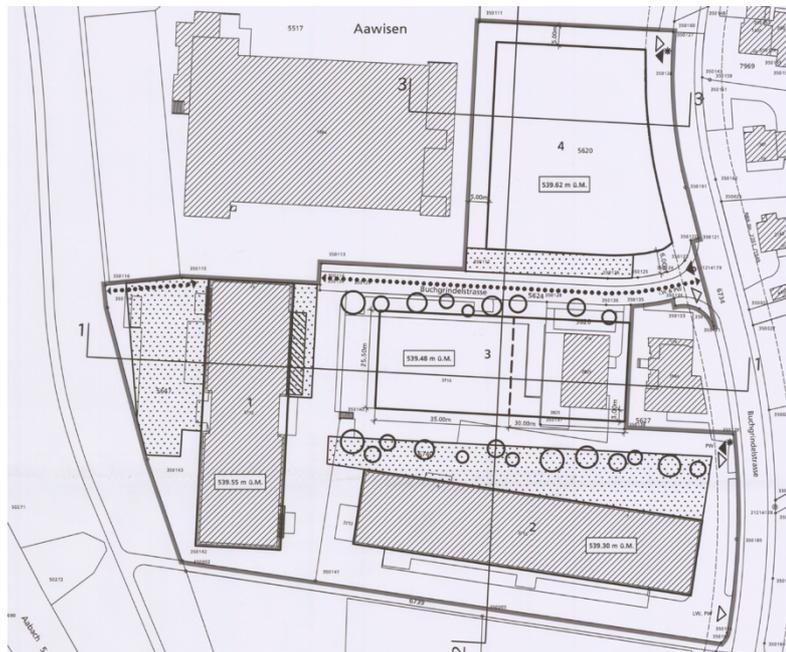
Rechtsgültiger Gestaltungsplan, Situationsplan 1:500, genehmigt 25. April 2012
